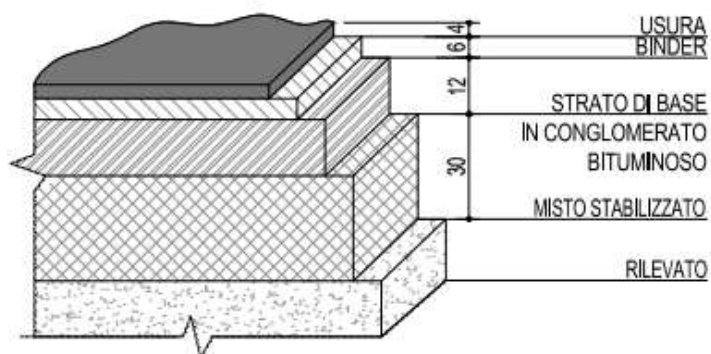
Particolare del Pacchetto 2 della nuova pavimentazione stradale
